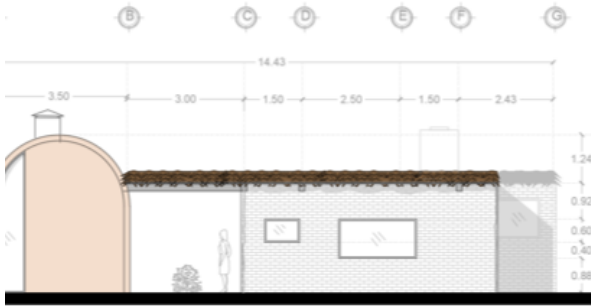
Fachada sur de vivienda. NOTA: elaboración propia.
